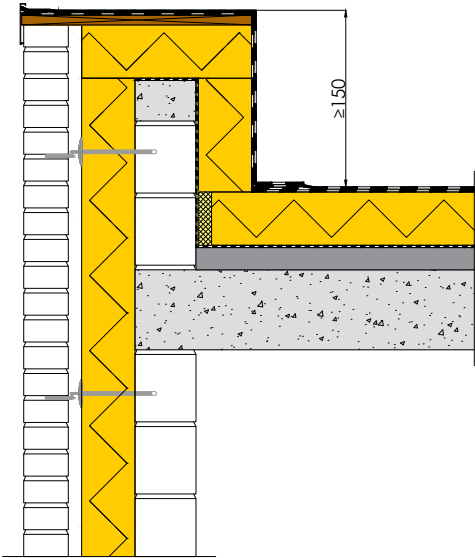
Hauteur de l'acrotère pour toiture avec lestage
